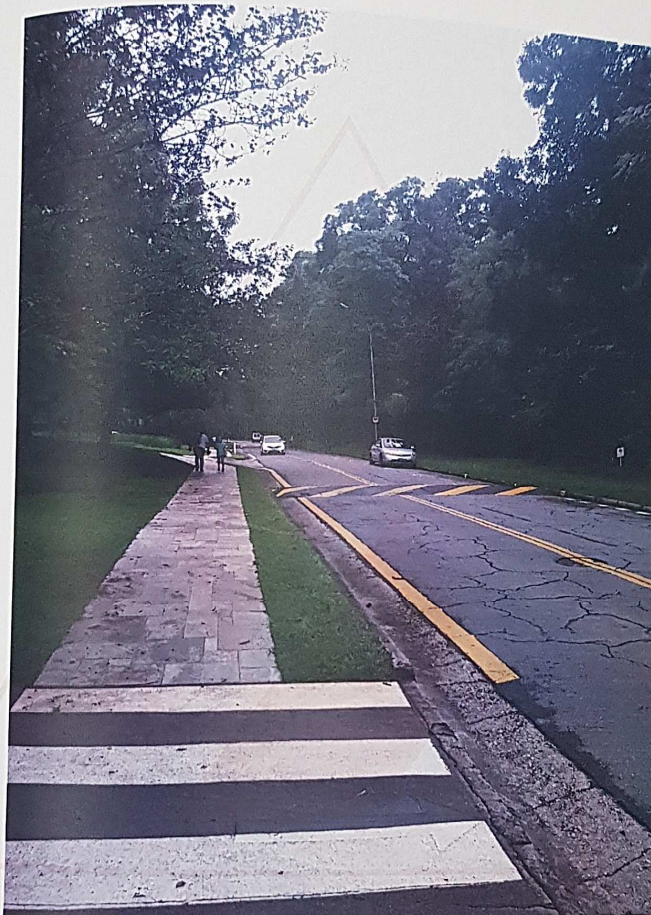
OUTRA VISTA EM SENTIDO CONTRÁRIO.
